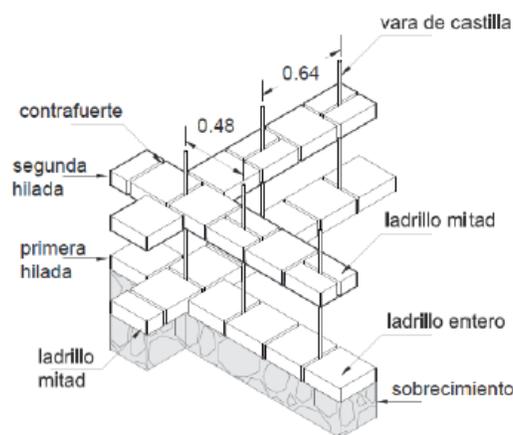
detalle de Refuerzo Vertical des opción de ventilación int
